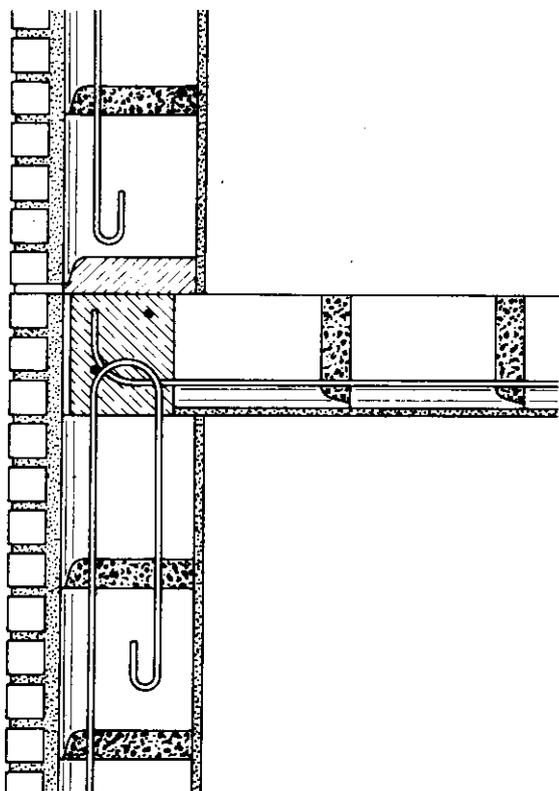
Bewehrte waagerechte Stöße zweier Außenwandtafeln und einer Deckenplatte einschließlich Ringbalken
